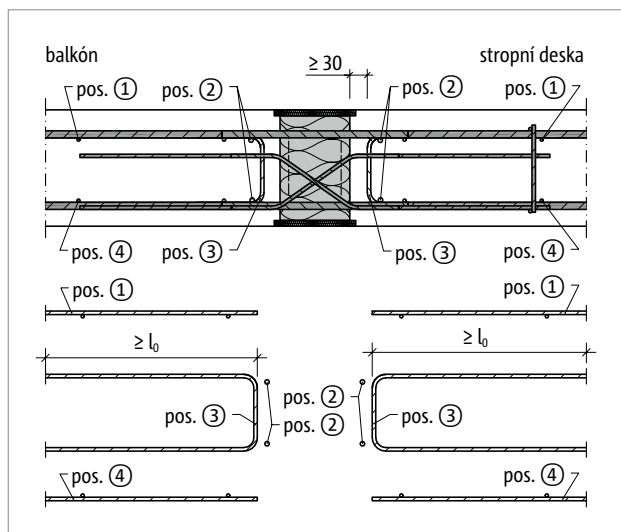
Schöck Isokorb® XT typ DP-MM6-VV1: Půdorys
